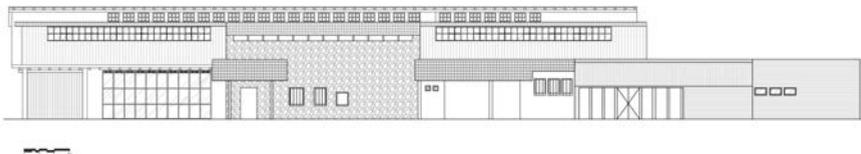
Lucio Costa, *Park Hotel*, 1944, Fachada Norte, Modenatura. Fonte: MEIRELLES, 2020.
